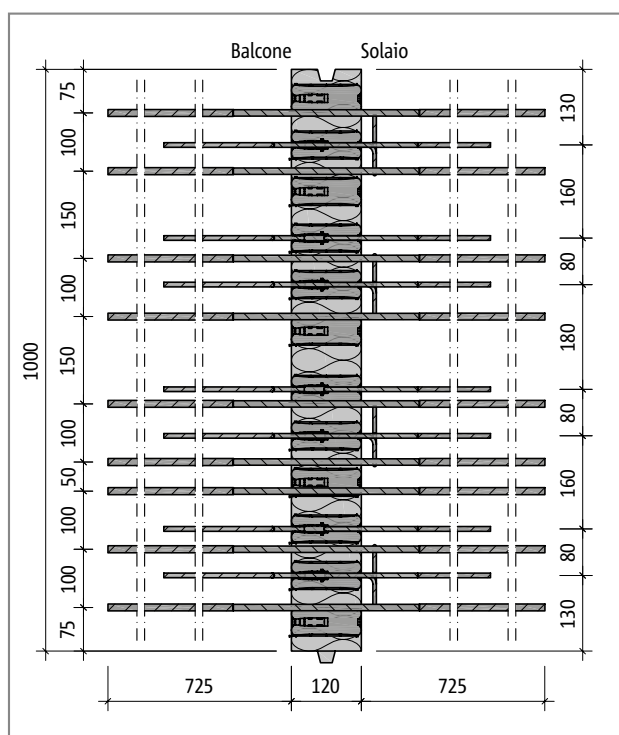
Schöck Isokorb® tipo KXT65: pianta del prodotto
